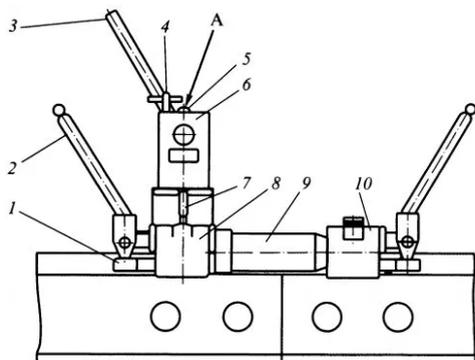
Легкий разгонщик РЛ-12: 1 – клин; 2 – рукоять для переноски и установки; 3 – рабочая рукоять насоса; 4 – вороток спускного клапана; 5 – пробка для заливки масла; 6 – бачок; 7 – аварийный клапан; 8 – корпус; 9 – гидроцилиндр; 10 – корпус; А – срезать перед вводом в эксплуатацию
